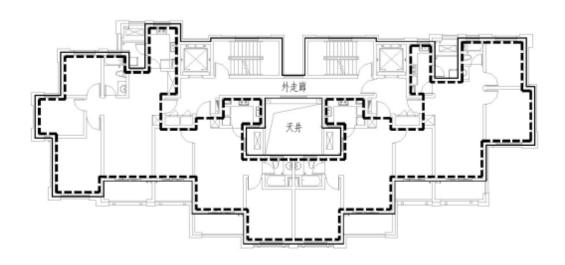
复合板内保温系统设置范围平面示意图
